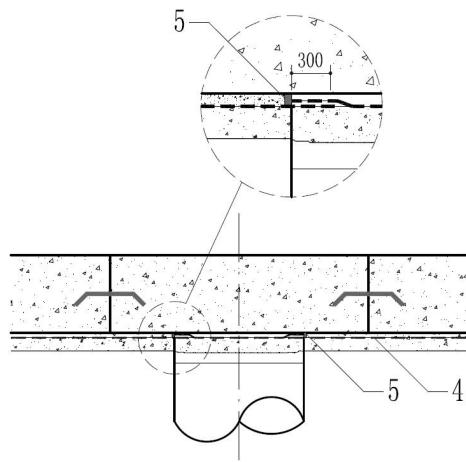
(b) 钢筋混凝土立柱凿除后防水施工示意图
